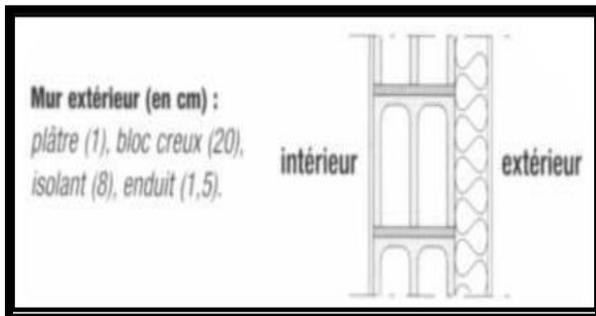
Exemple de parois à forte inertie thermique en maison individuelle cas du mur : extérieur (en cm) source : C.S.T.B .2004
